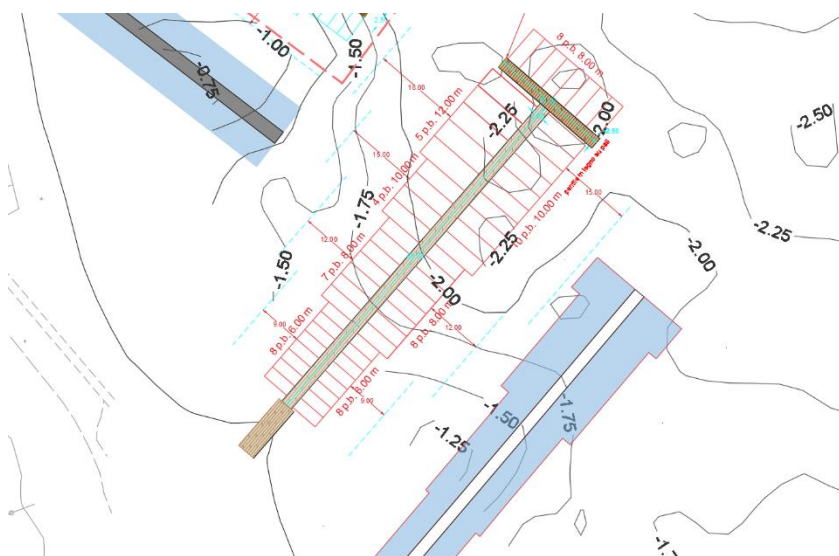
Stralcio planimetrico nuova struttura di ormeggio
